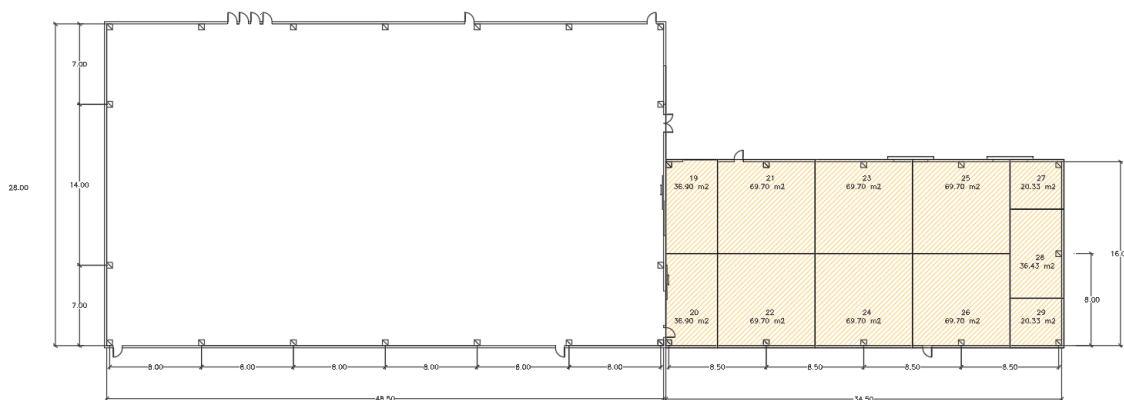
Disposició pilars magatzem (Cotes en Metres). Font: Elaboració pròpia
